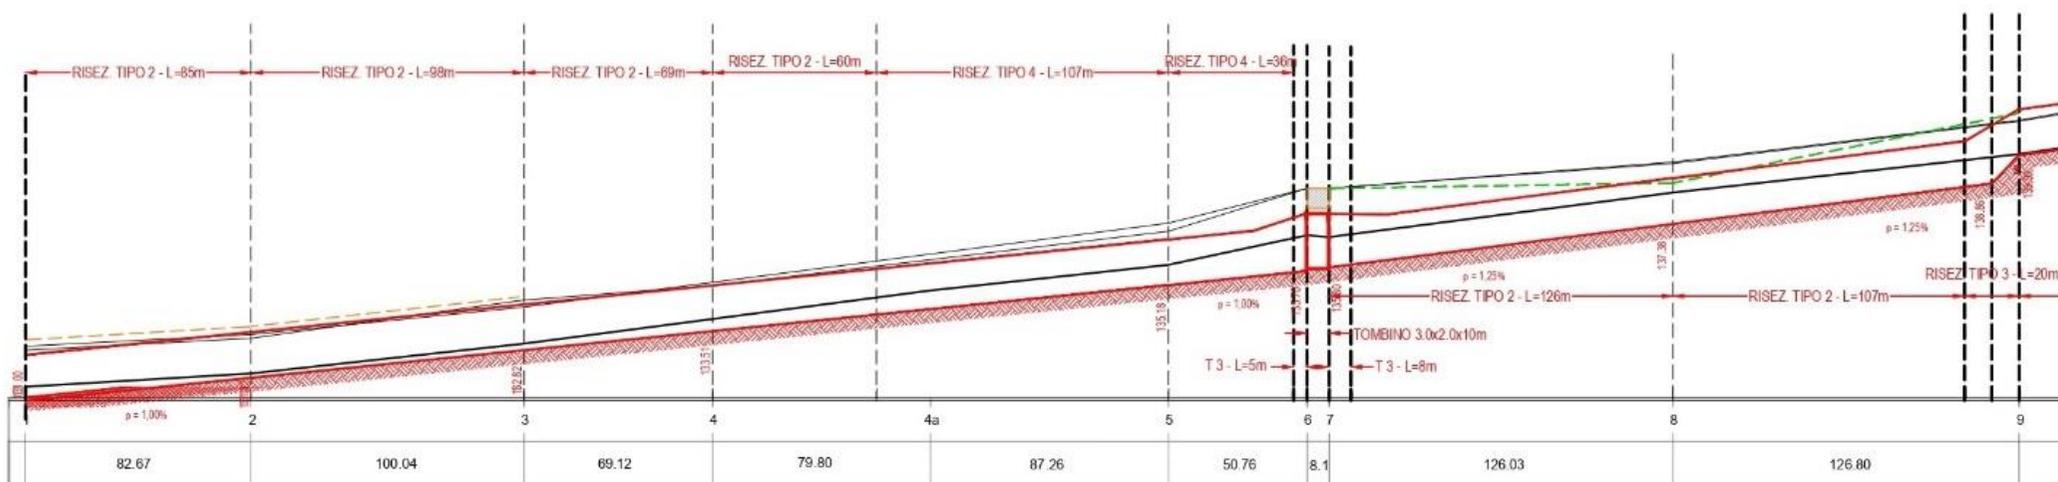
RIO ENZOLA, PROFILO LONGITUDINALE DI PROGETTO, TRATTO DA SEZ. 9 A SEZ. 0
